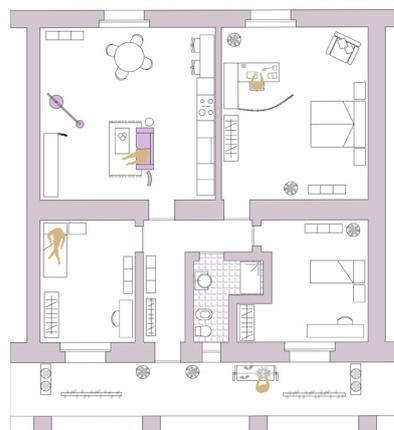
Rappresentazione planimetrica appartamento Casa Ballatoio con arredi.
